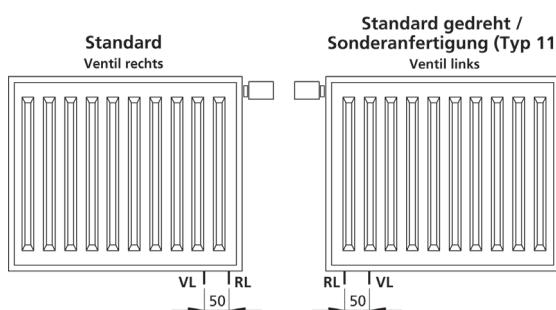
Anschlusslage Ventil rechts und Ventil links
